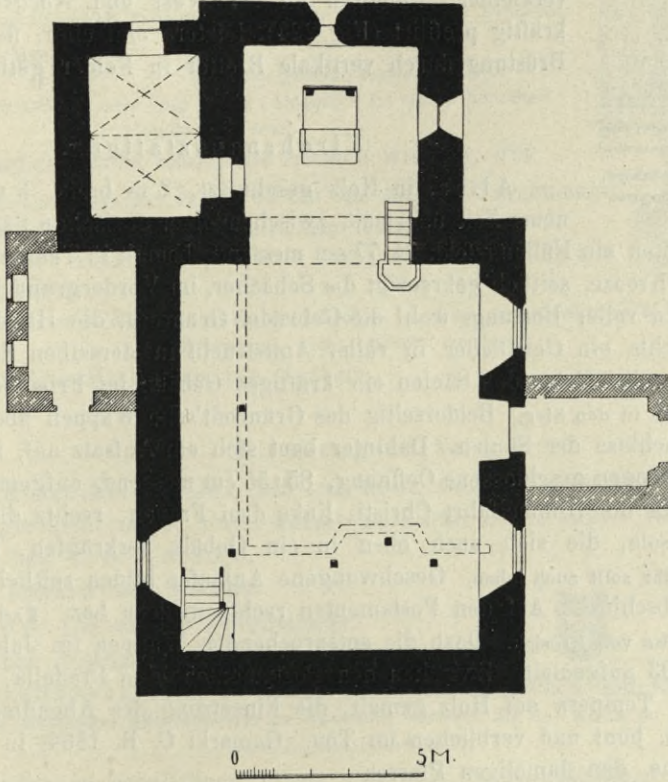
Schönborn, Grundriss der Kirche.
